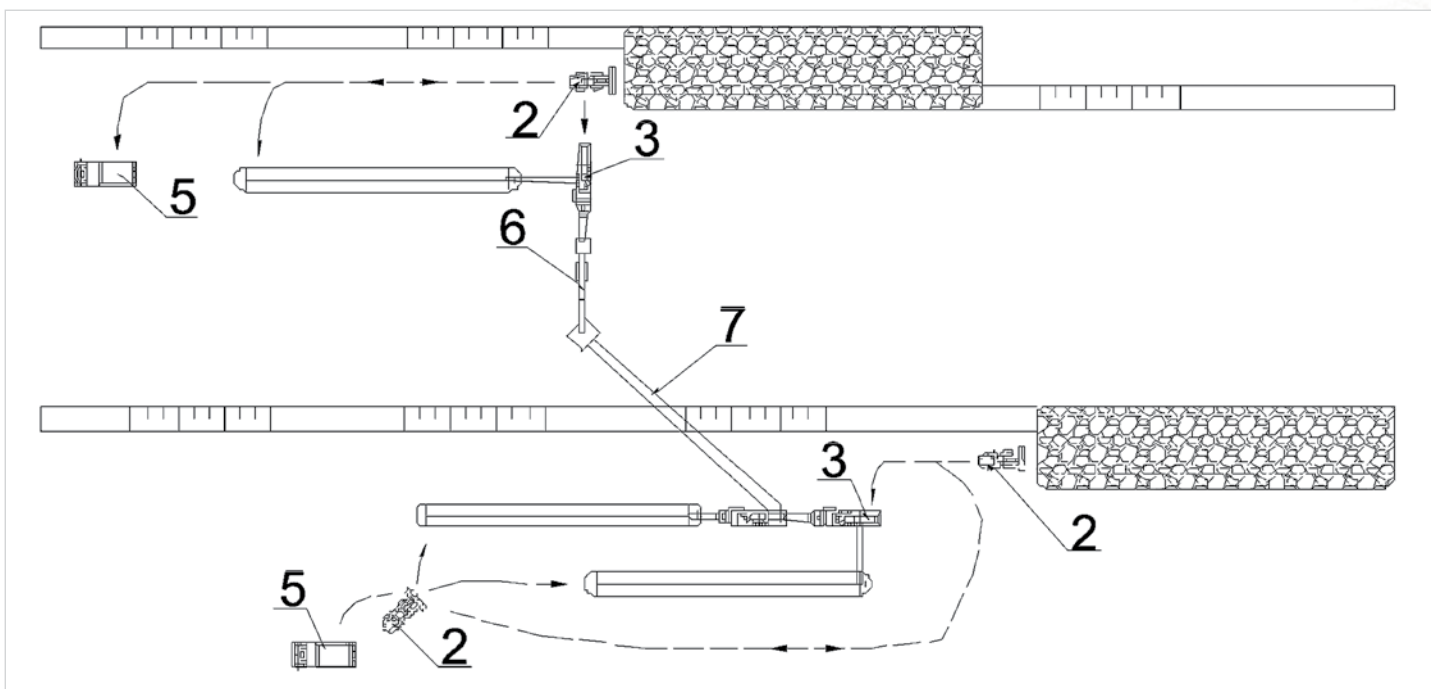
Схема разработки горных пород с торцевым расположением (МДК) при использовании погрузчика и догрузкой дробилки на смежном уступе: 2 – погрузчик; 3 – мобильный дробильный агрегат (МДА); 5 – автосамосвал; 6 – мобильный телескопический конвейер; 7 – конвейер передвижной ленточный межуступный
